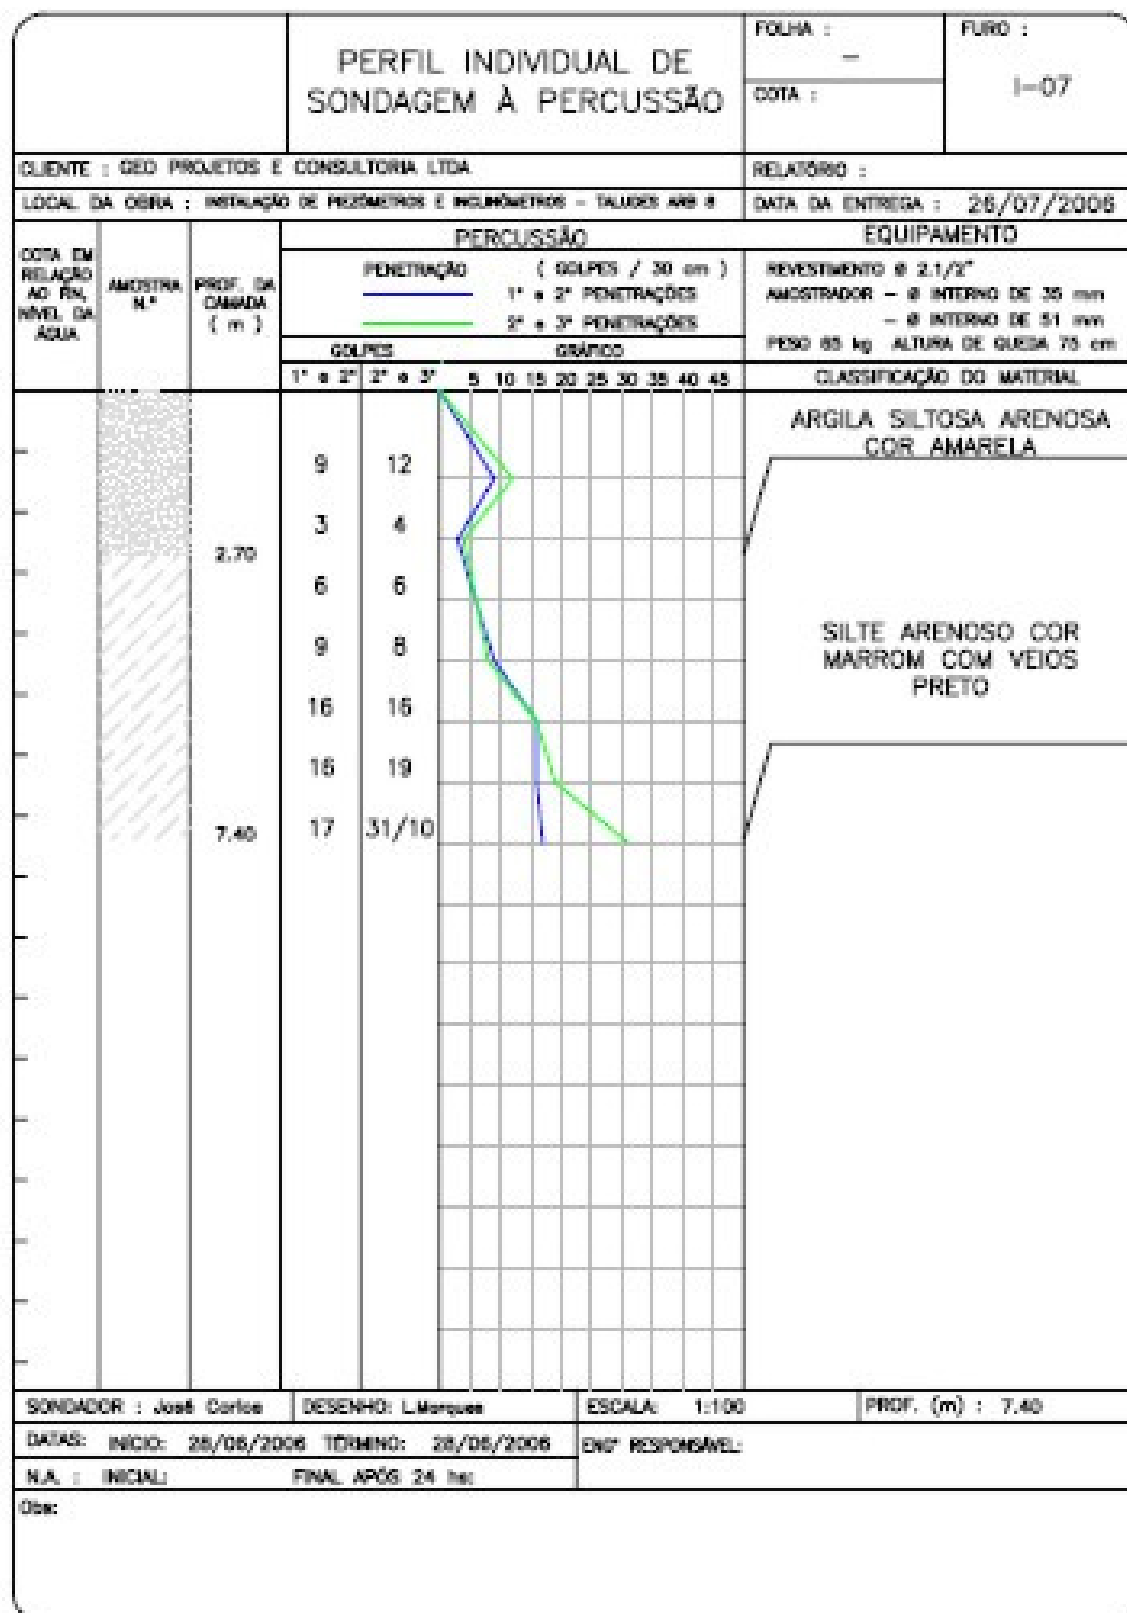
Perfil de sondagem do furo do inclinômetro I-7.
